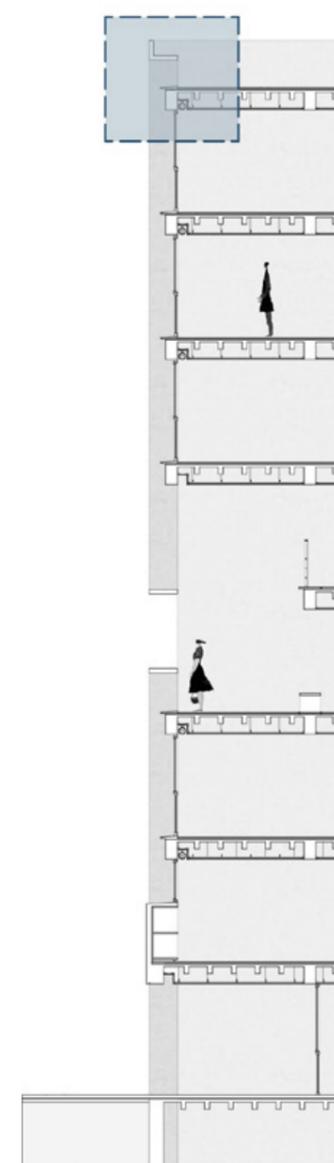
Ubicación del detalle constructivo 1. Fuente: Elaboración propia.
